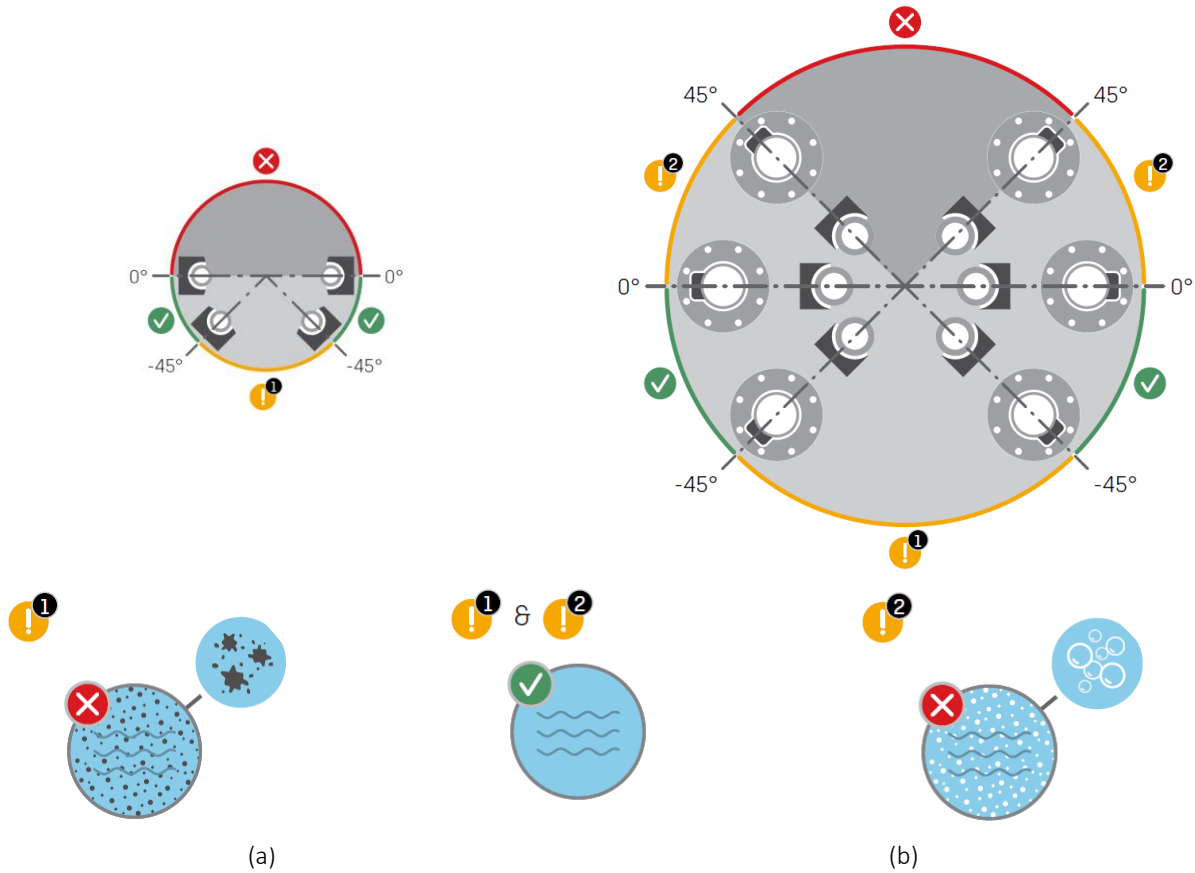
Akzeptable Orientierung der Kamstrup-Durchflusssensoren um die Rohrachse für Wärmeinstallationen bei waagerechter Montage. (a) Zählergehäuse mit Gewinde mit $q_p \leq 2,5 \text{ m}^3/\text{h}$. (b) Zählergehäuse mit Gewinde mit $q_p \geq 3,5 \text{ m}^3/\text{h}$ und Zähler mit Flansch.
